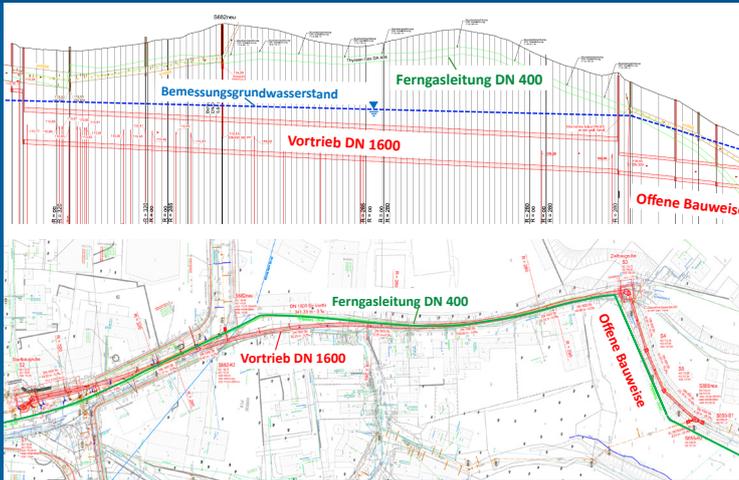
Lageplan und Höhenplan der Kanaltasse
